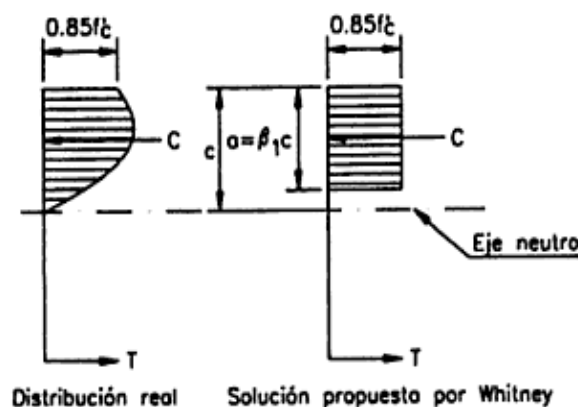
Distribución de esfuerzos en el concreto en compresión de la viga
